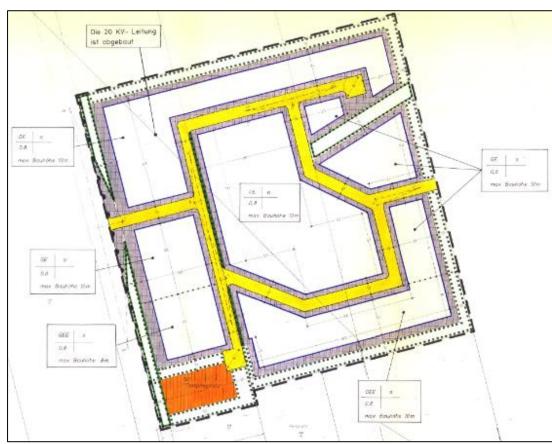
Ursprungsbebauungsplan Nr. 28 "Kirchdamm/ Seehausen"
